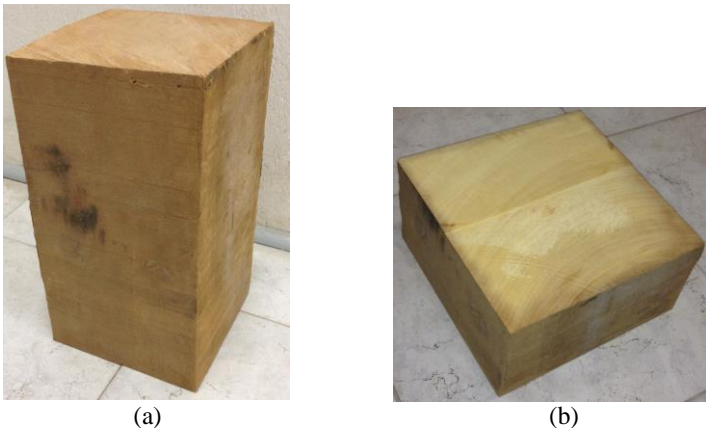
Garapeira utilizada no ensaio (a) viga original (b) corpos de prova de 10 cm de comprimento
